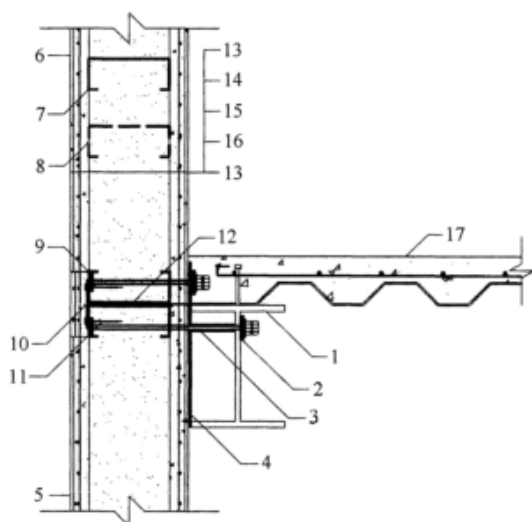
同层相邻且中心线垂直的轻钢桁架轻混凝土单元剪力墙板与钢管混凝土柱螺栓连接
